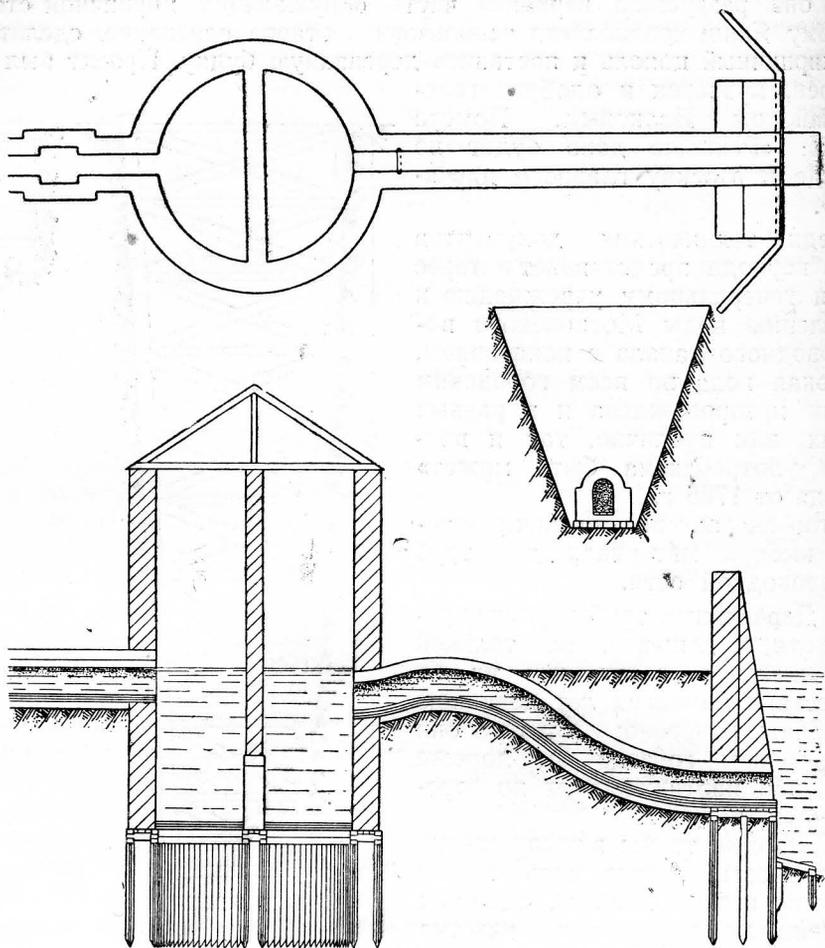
Выпуск на Трубе из Мытищинского водопровода.
